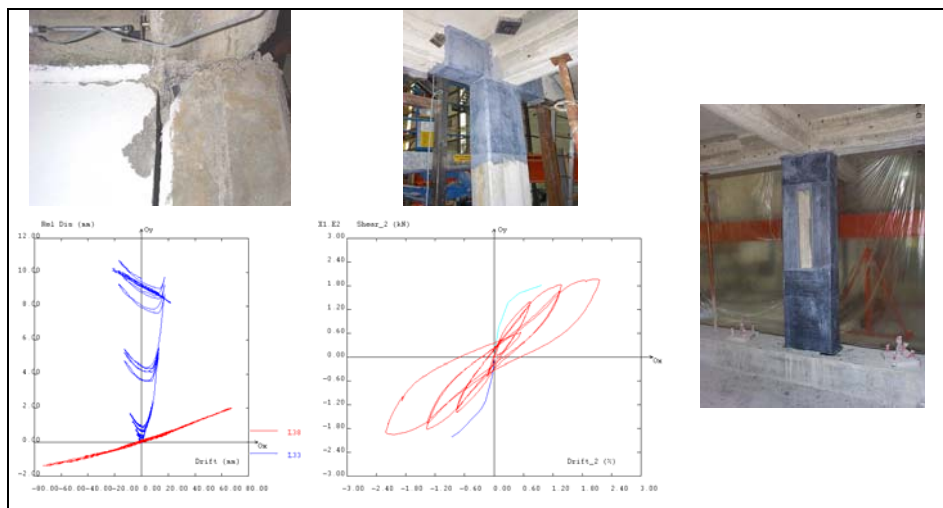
Rotura dos pilares exteriores (ligação pilar/nó); Pilares reparados (exterior e interior do primeiro piso); Deformação ao nível do pilar exterior e Curvas força-deslocamento.
